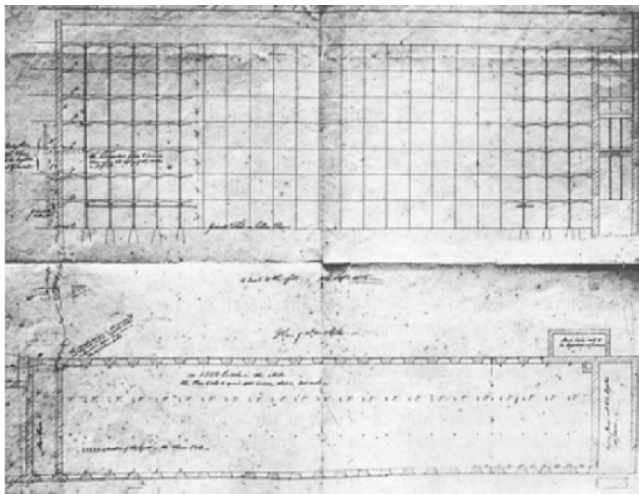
Planimetrie Fabbrica Bulton e Watt_ Espacio tiempo y arquitectura (pag 212)
